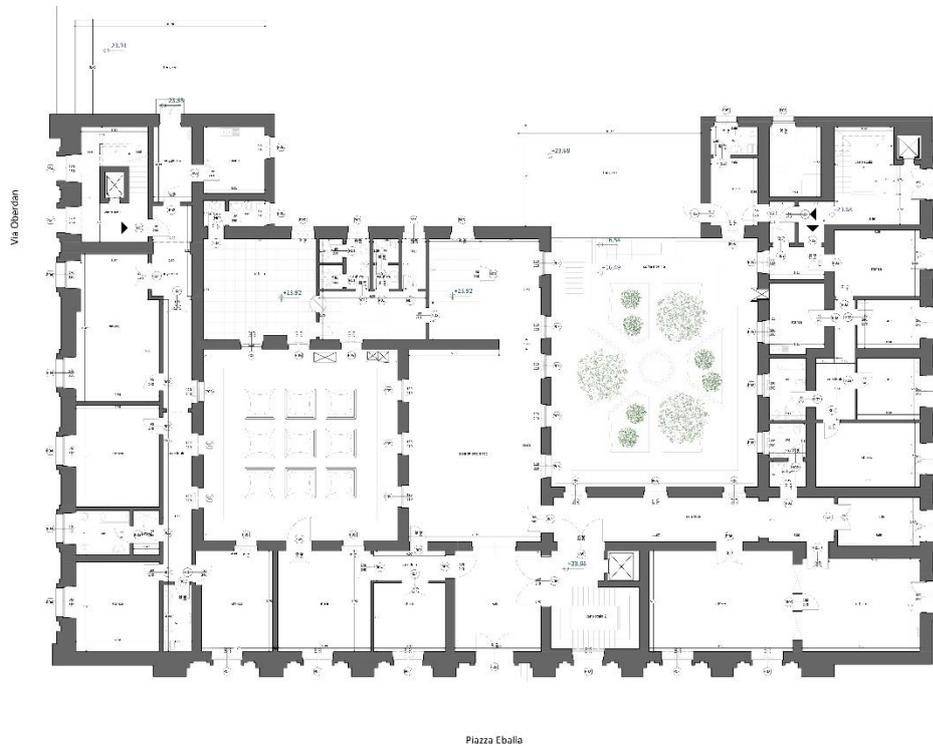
Pianta piano primo. Rilievo architettonico a cura dell'Ing. Giorgio Tonti.
